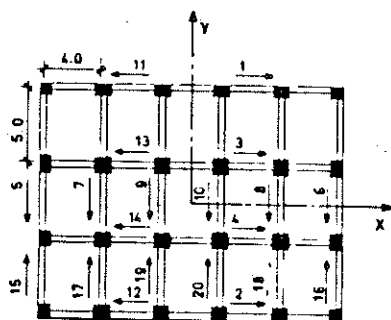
Planta do edifício Pórticos (1-10); painéis (11-20).
